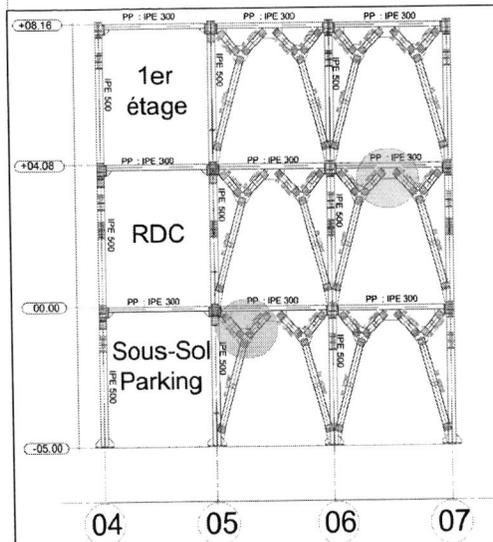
Coupe sur un contreventement vertical en forme de V renversé. ECH 1/50
